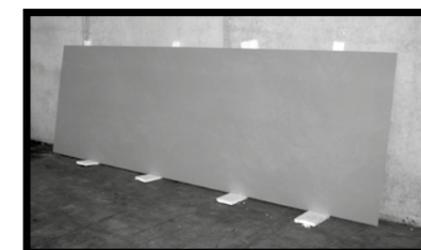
En cas de position verticale, poser le côté long de la dalle sur une surface en bois.
